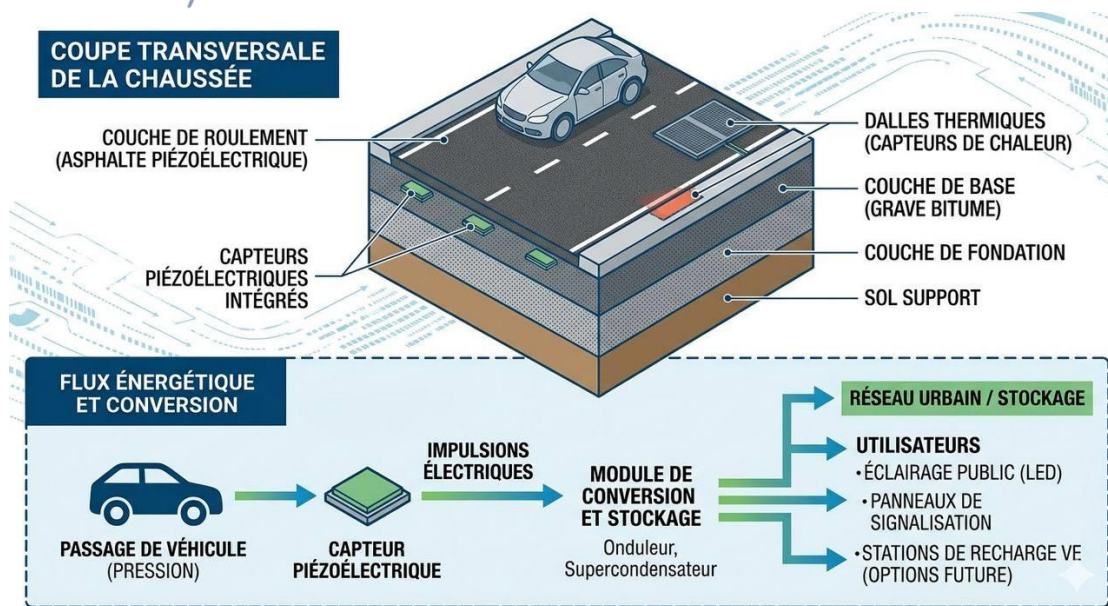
schéma de la section de route équipée en dalles piézoélectriques
